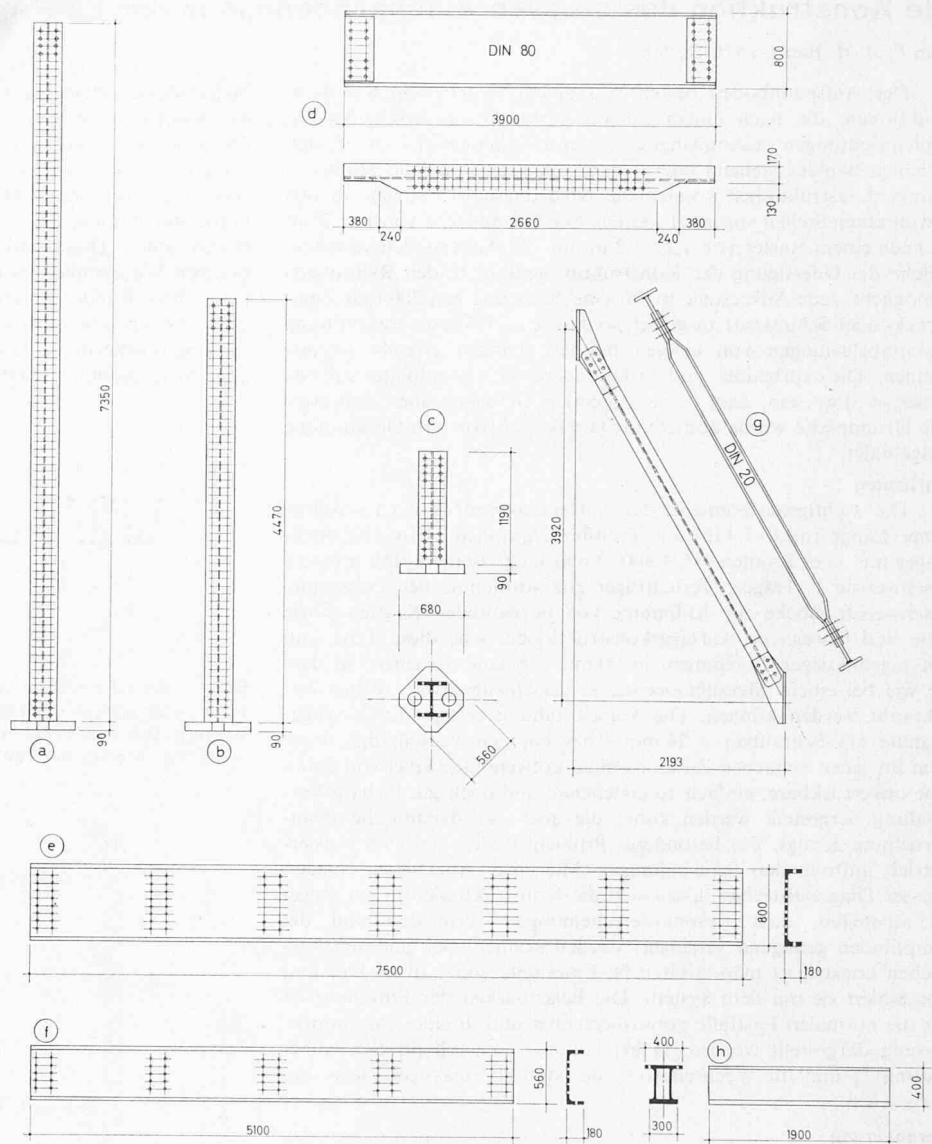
Aufbauten-Einzelteile, Masstab 1:80. Die wichtigsten Einzelteile, aus denen Aufbauten zusammengesetzt werden können: a)b)c): Stützen aus HEB 360; d): Jochträger aus HEB 800; e): grosser U-Träger, geschweisst; f): leichter U-Träger, geschweisst; g): Streben; h): Verteil-träger
